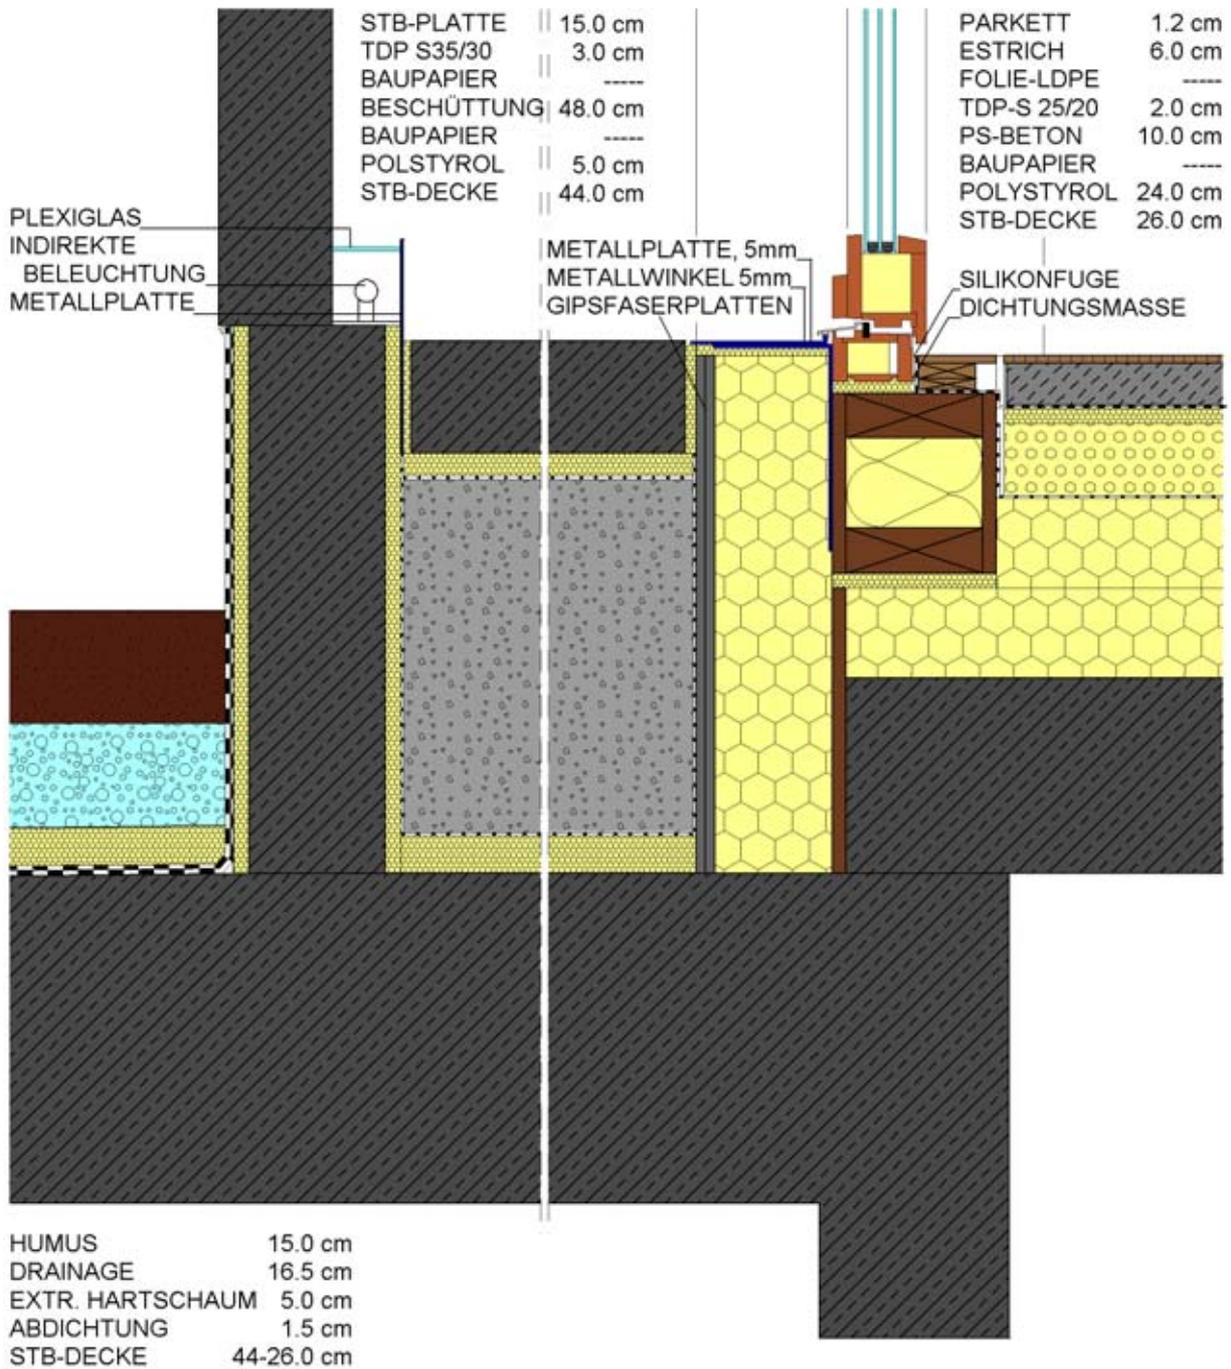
Detail Eingangstür Erdgeschoss, unterer Anschluss
